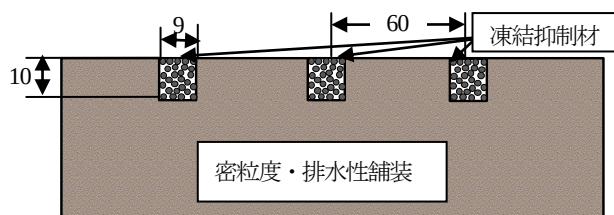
グルーピング系凍結抑制舗装の断面図 (単位: mm)
